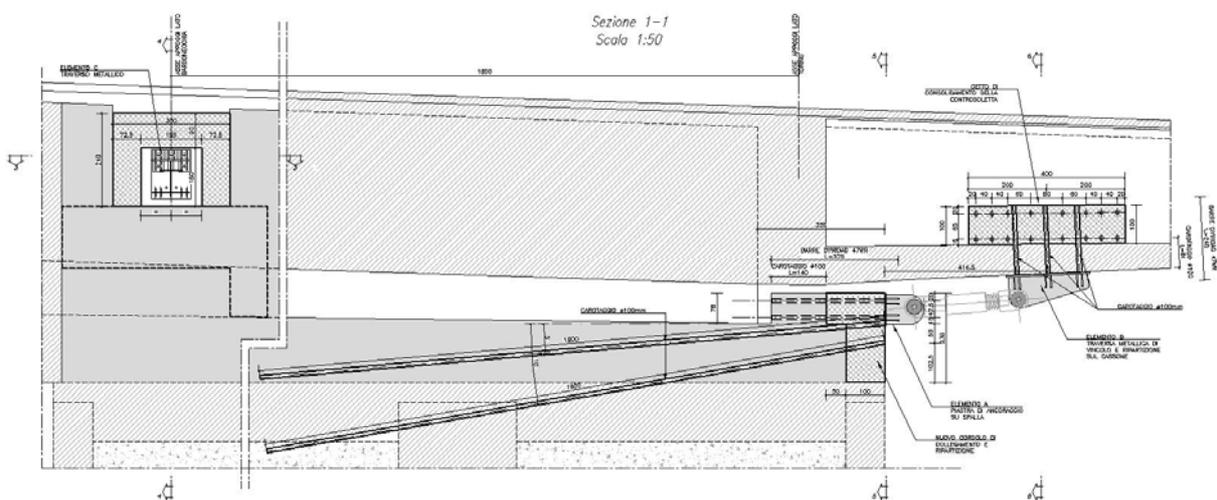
Spalla Sp.3 - Sezione longitudinale
